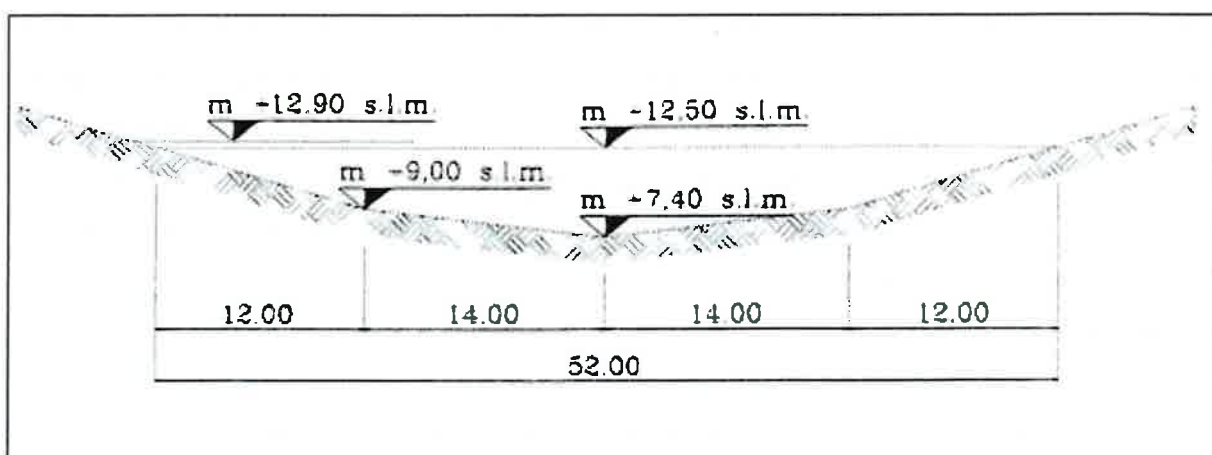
Sezione tipo (immagine ricavata dall'archivio storico di Mantova).
